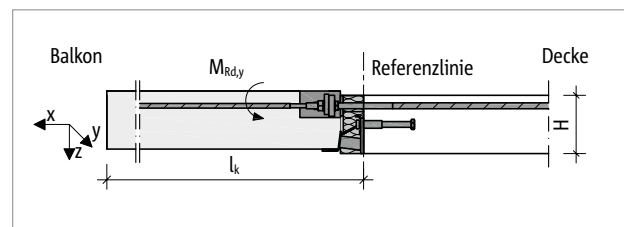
Schöck Isokorb® IQ Typ K-B: Statisches System
